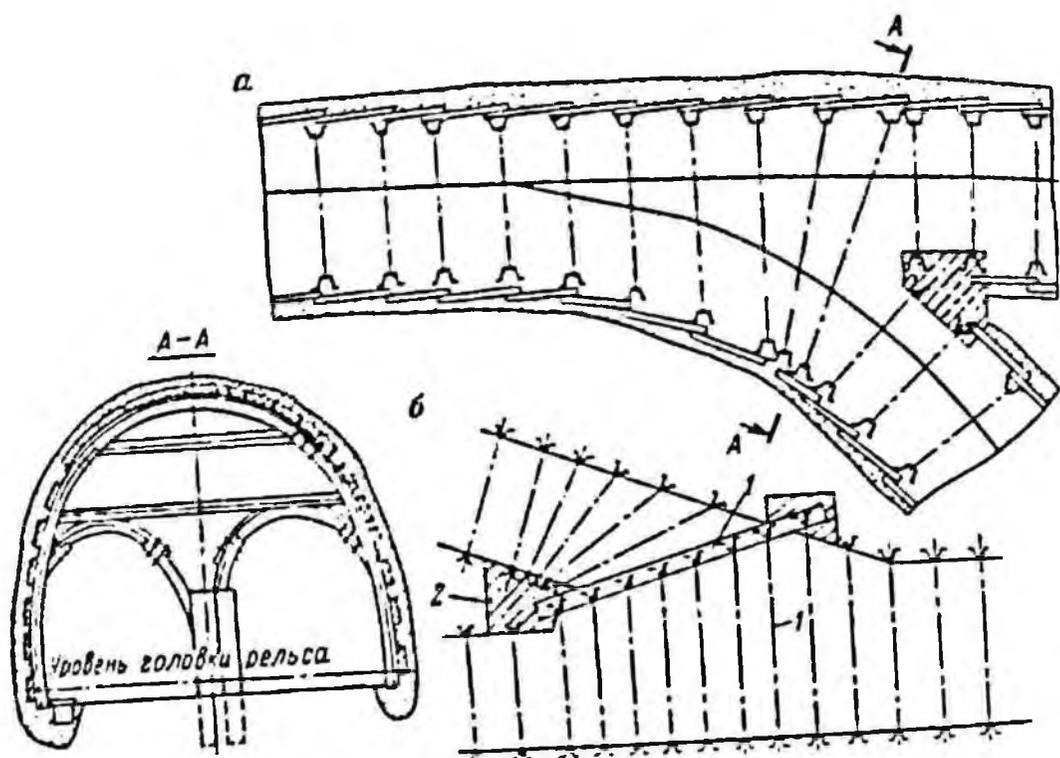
Схема крепи сопряжения выработок с металлической арочной крепью:
